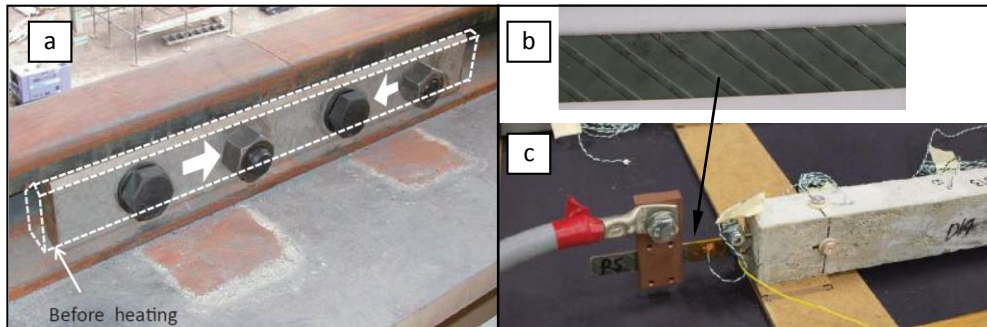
a) Unión de rieles de puentes-grúa con planchuelas con MF [S16]. b) Planchuela de acero con MF pretensada (estirada), y c) construcción de vigas de hormigón pretensado con las mismas. En este caso la temperatura de reversión se alcanza por aplicación de energía eléctrica, utilizando el efecto de resistencia eléctrica del metal [C15].
